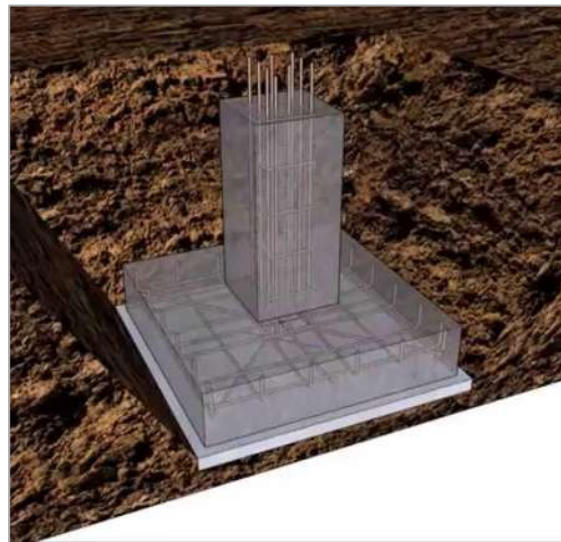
| Isométrico de zapata aislada y plantilla de cimentación.
